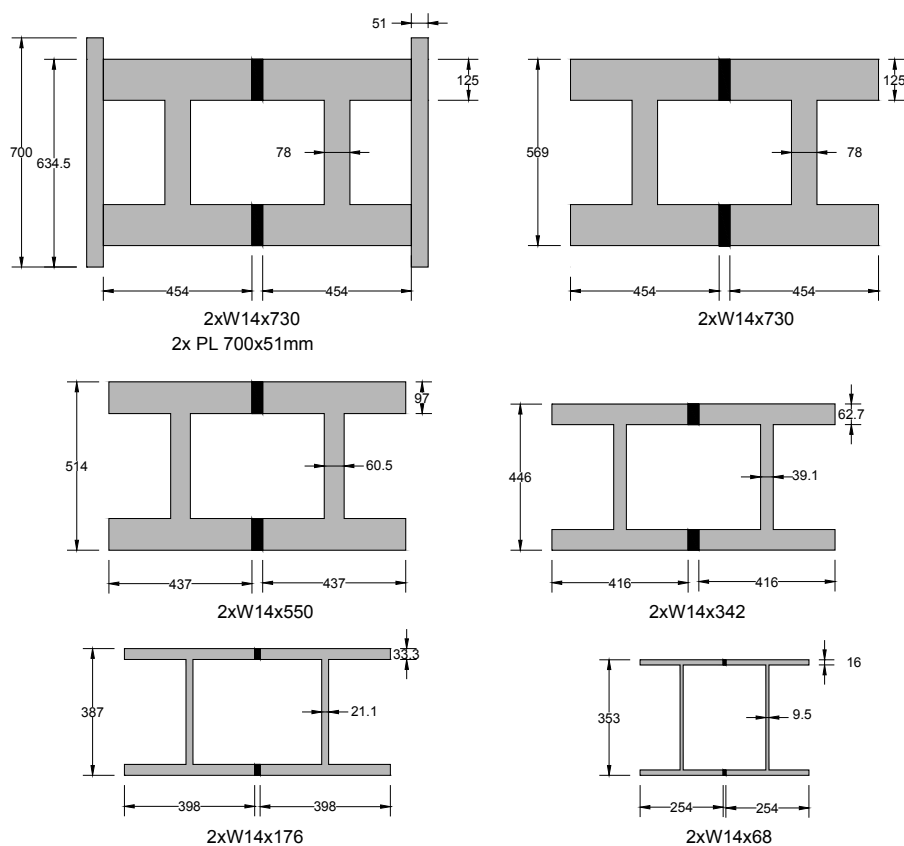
Secciones Transversales Columnas en Sistema de Contravientos
